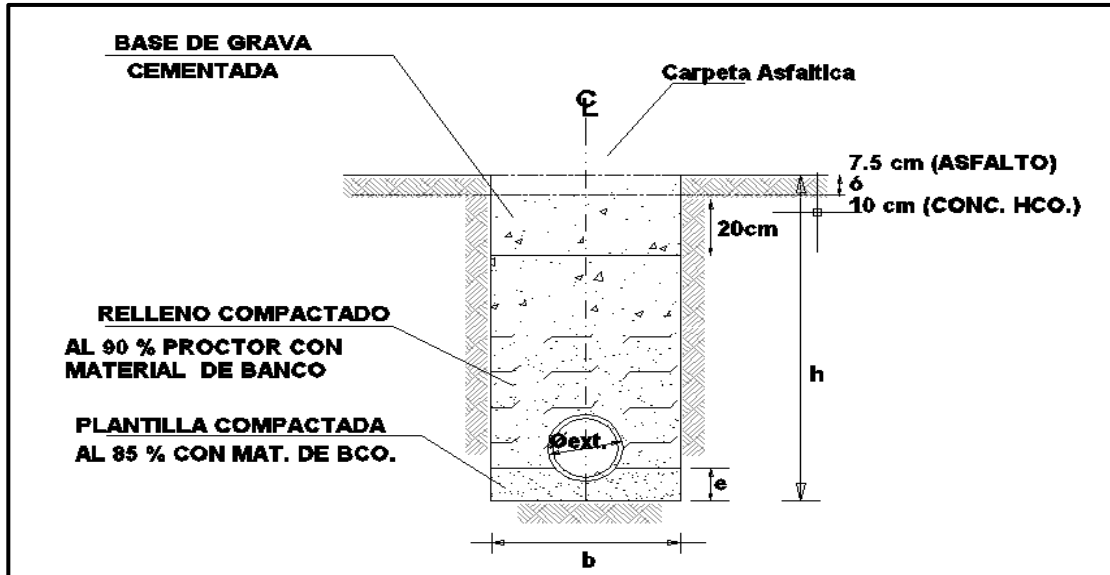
Vista en corte de sección transversal de una sección de zanjas de colocación de la red de drenaje en proyecto
